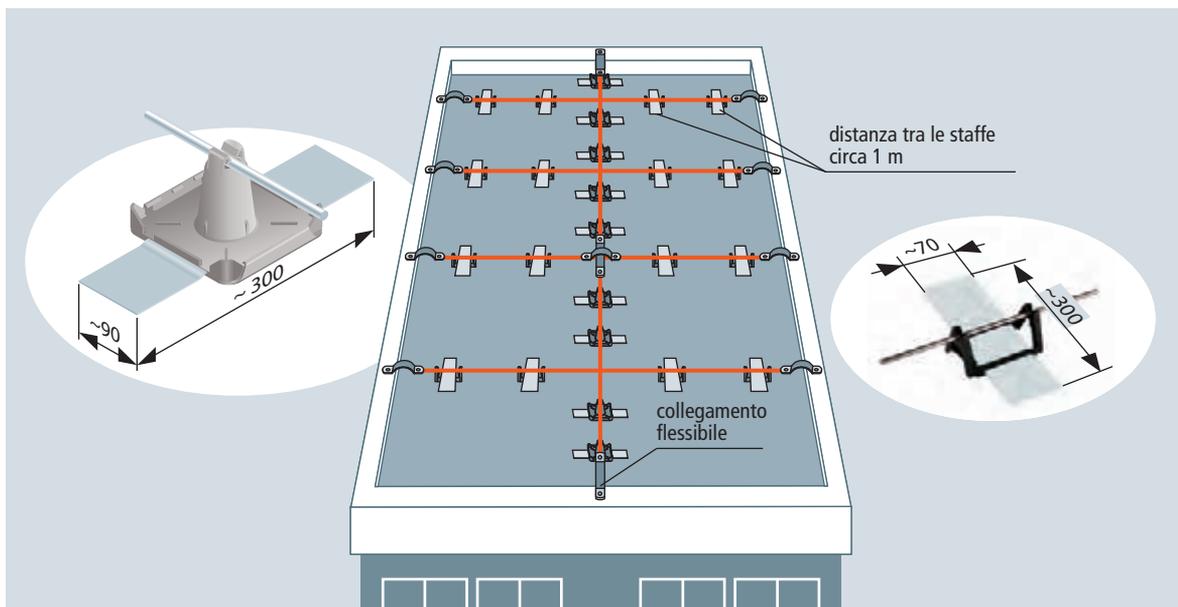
Guaina impermeabilizzante - staffa portafilo per tetto piano tipo KF / KF2
